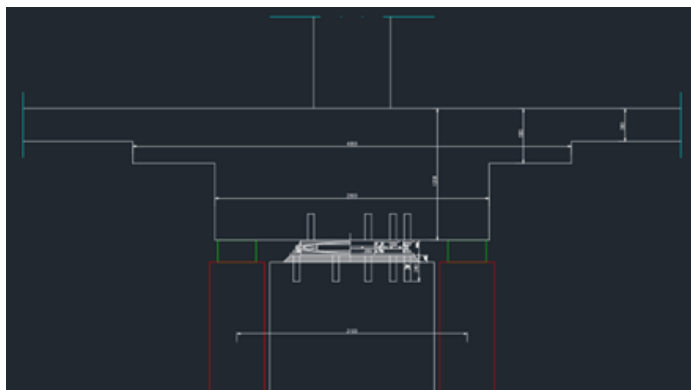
Ilustração do sistema de levantamento da estrutura (ARSLVT, 2026)
